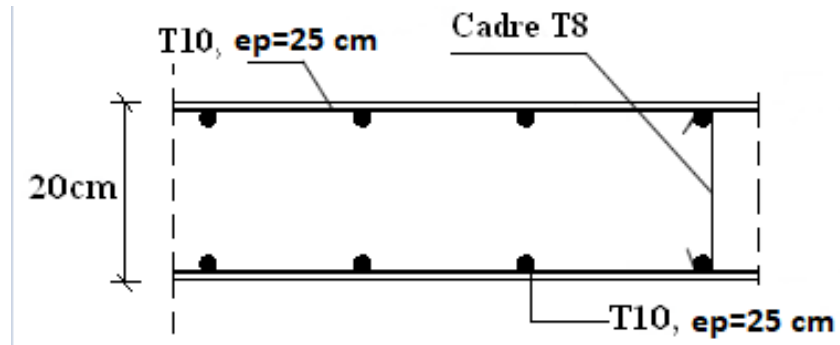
Ferrailage du voile périphérique sens y-y.
